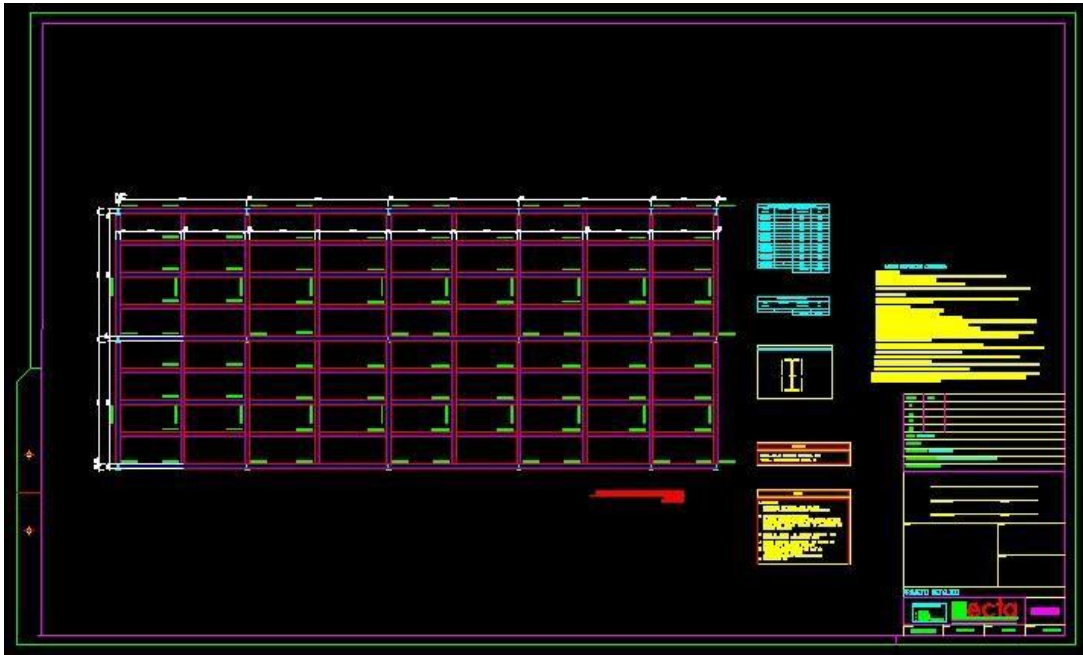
Forma do pavimento superior do projeto de estruturas metálicas do novo pavimento proposto (Eberick). (Fonte: Autor)
